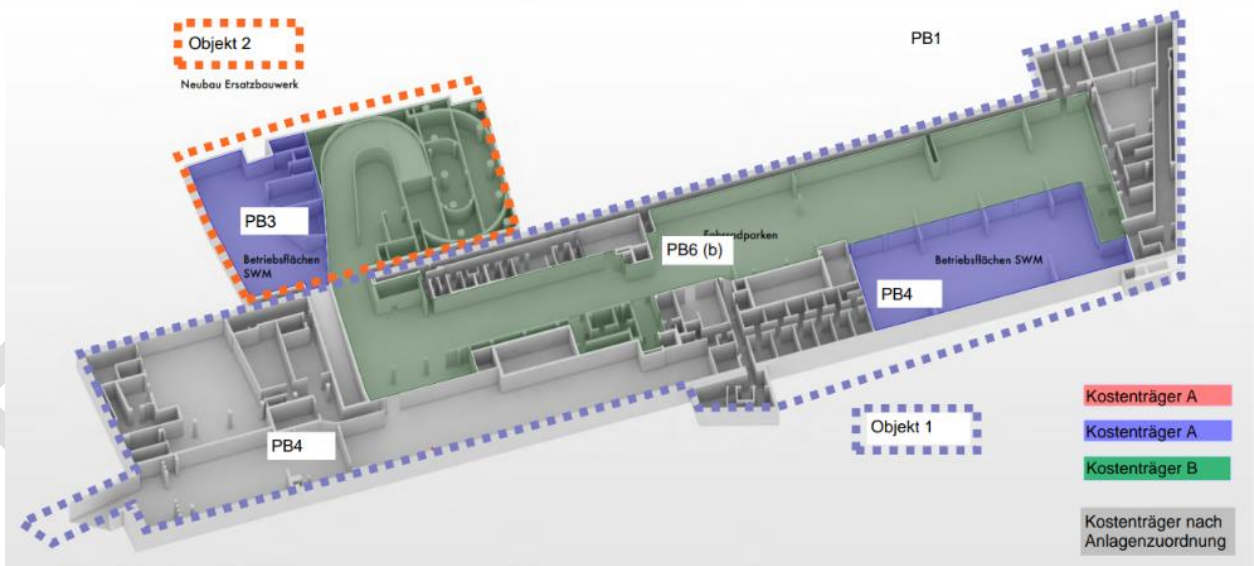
Einteilung Planungsbereiche – 2. Untergeschoss
